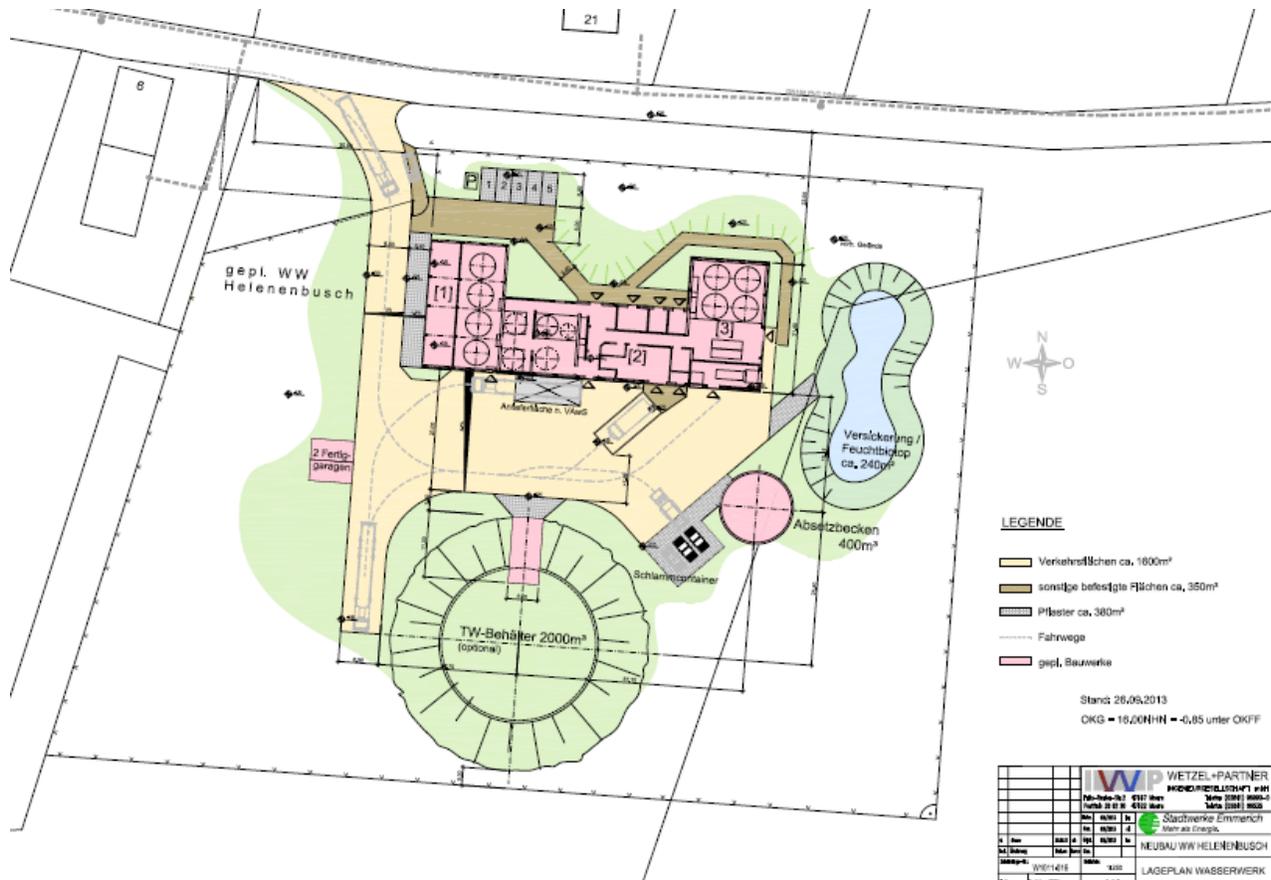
Bauwerksdetails. Quelle: WETZEL & PARTNER (2013).
